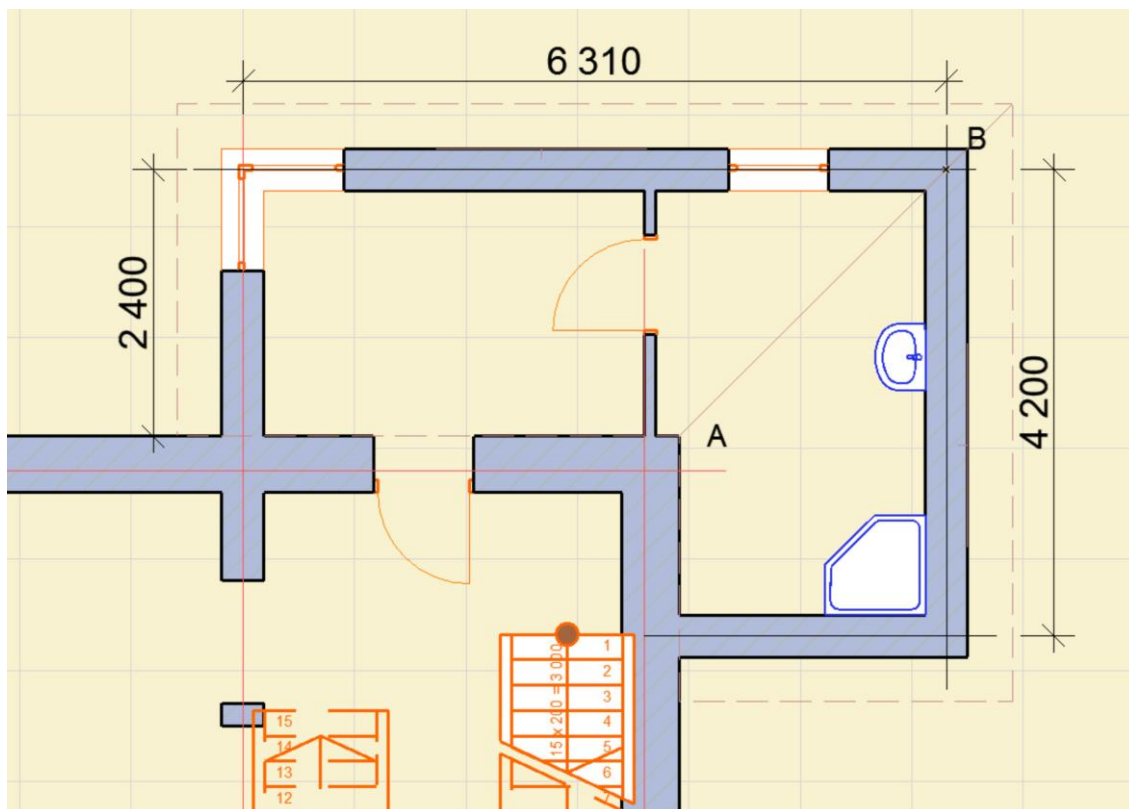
Размеры и планировка хозяйственной пристройки
